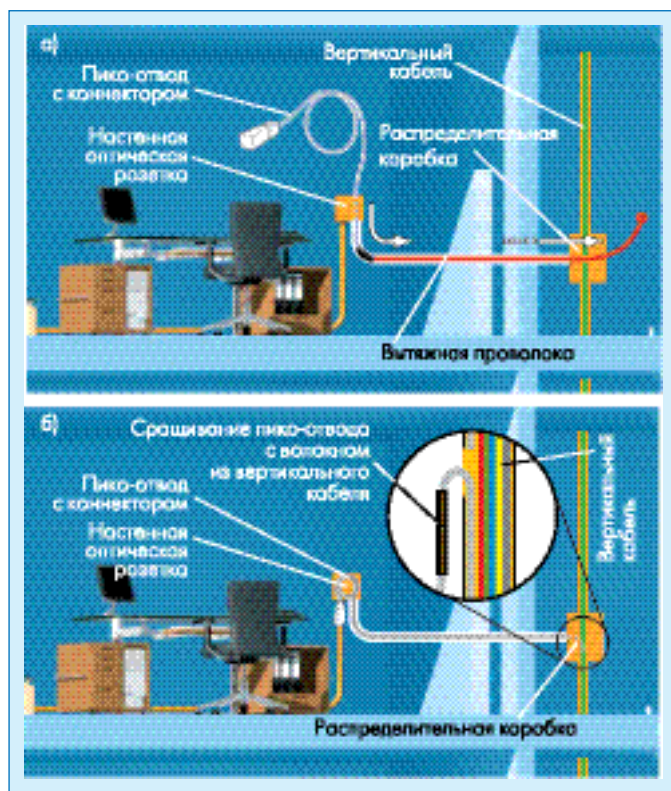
Фрагмент сети на уровне этажа: а – протягивание горизонтального кабеля, б – сращивание с вертикальным кабелем
